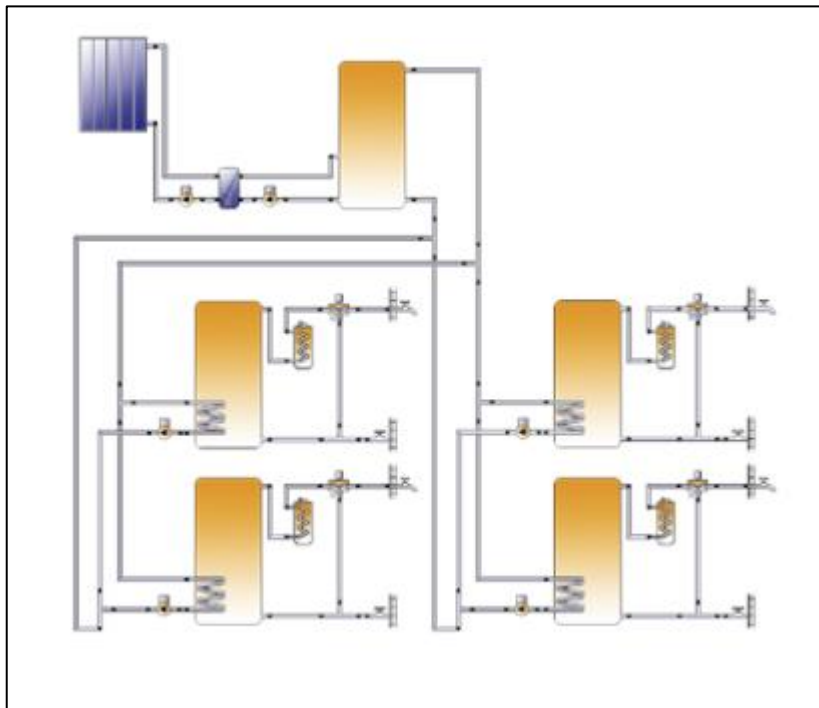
Configuración del sistema centralizado con apoyo individual distribuido
